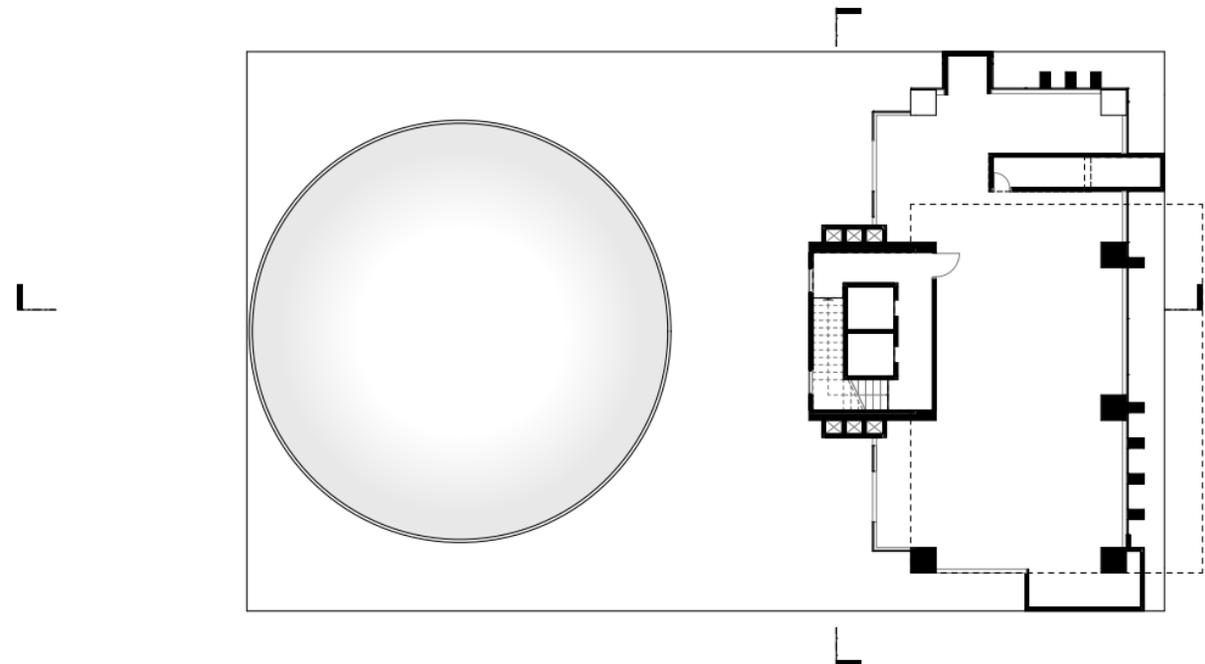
Planta alta planificada N+42.50. Fuente: Tesistas.
